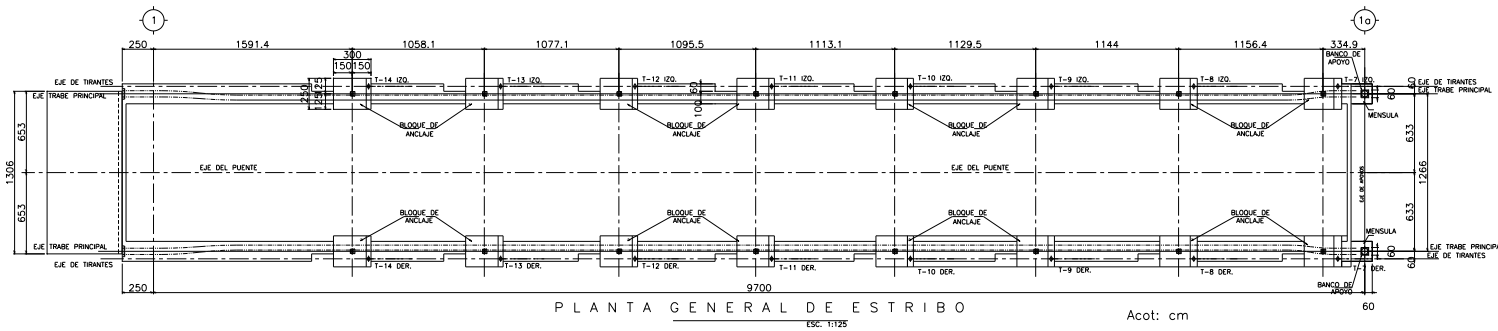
Vista en planta del estribo del eje 1 al 1a
